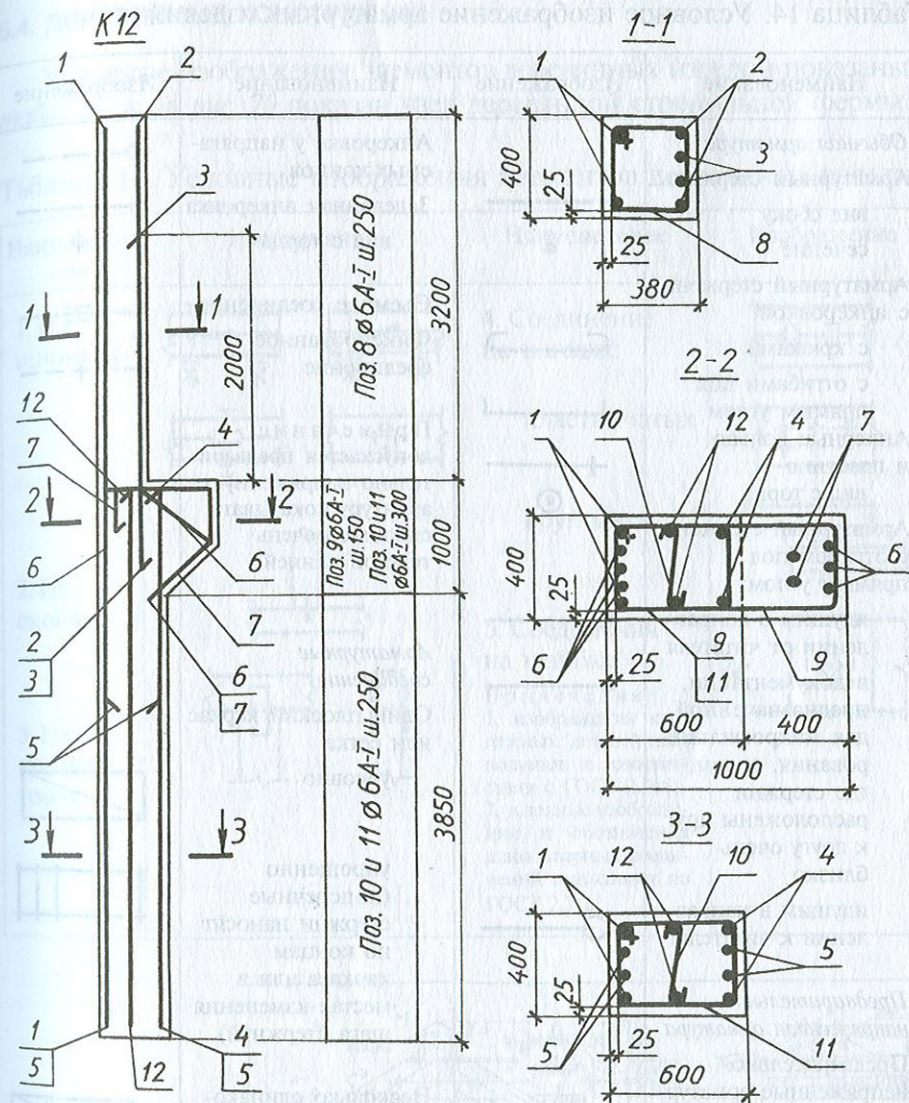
Пример графического оформления схемы армирования сборной железобетонной колонны:
